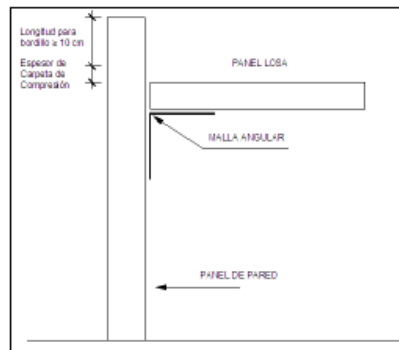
Ilustración típica unión losas y muros estructurales de paneles EMMEDUE
